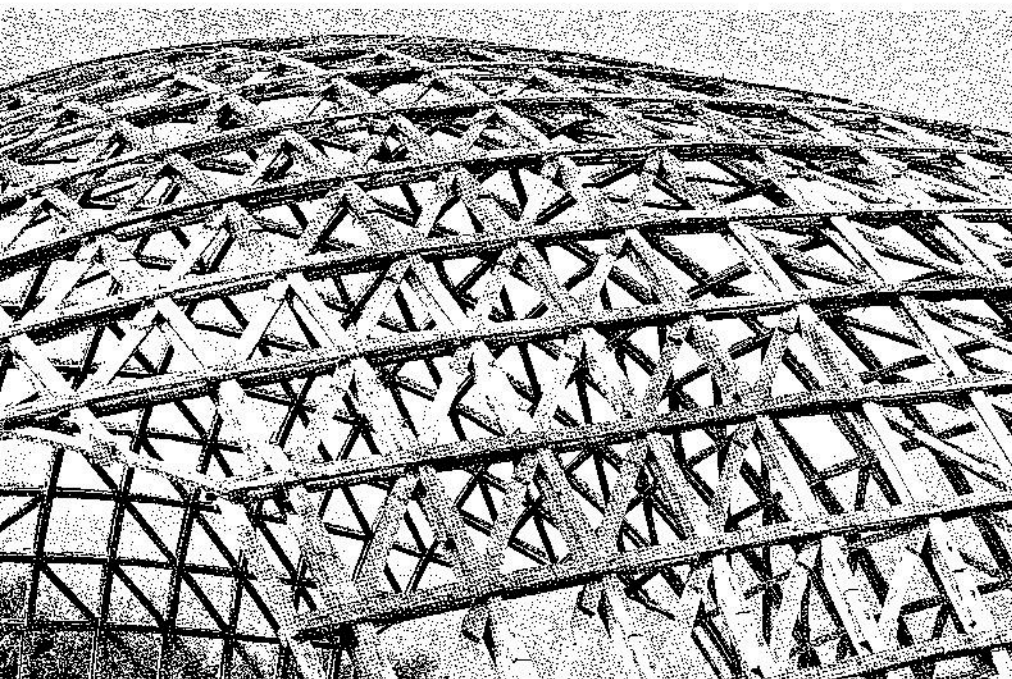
Malha estrutural de madeira. Fonte: www.gridshell.it
